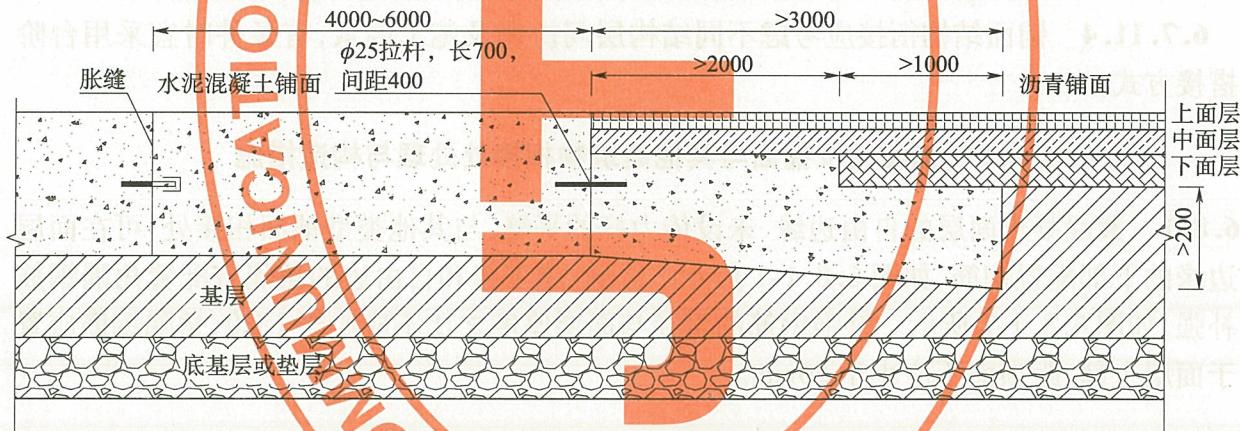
混凝土铺面与沥青铺面相接段的构造布置(单位:mm)
